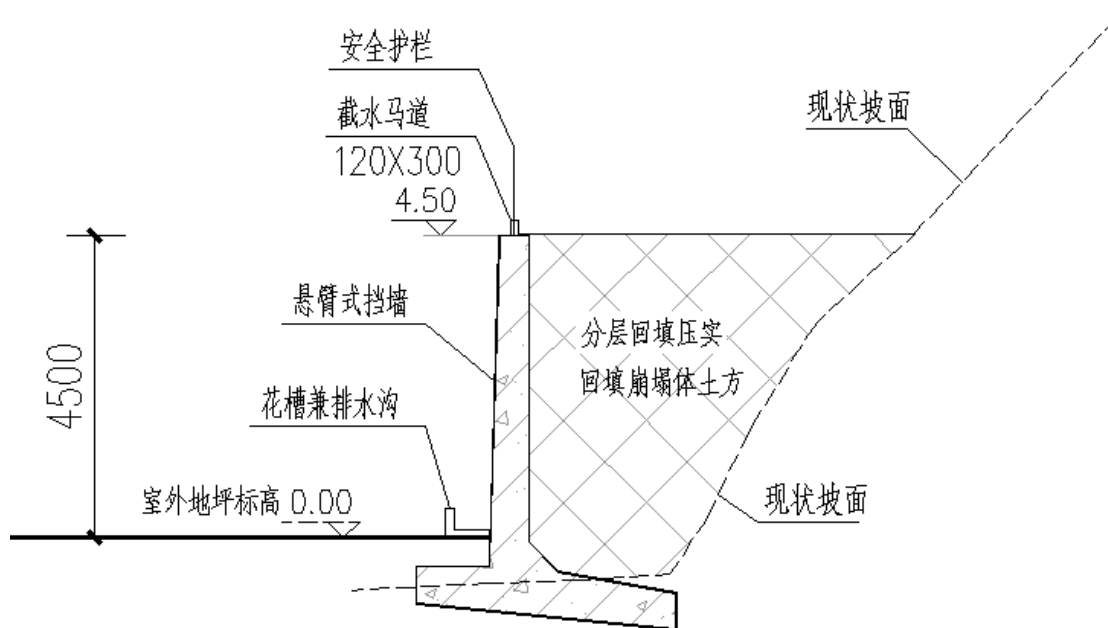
悬臂式钢筋混凝土挡土墙支护典型剖面
